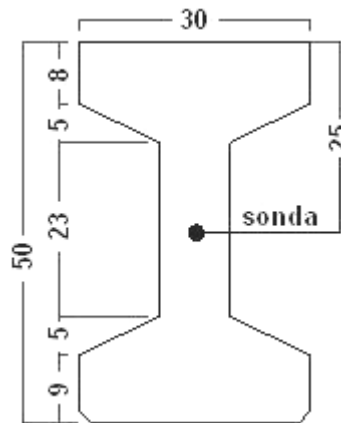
Dimensões da seção transversal da viga I 50 (em cm)
